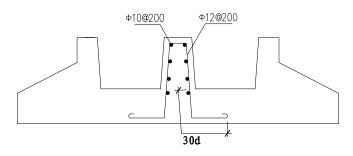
双杯口基础隔墙内配筋示意图
